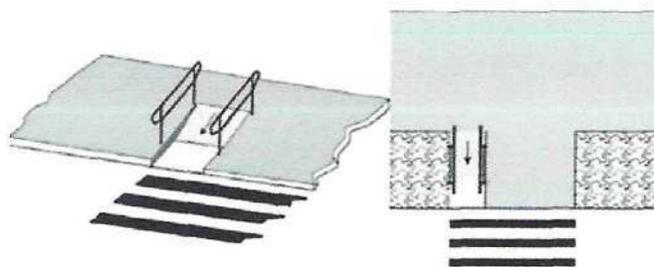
Вариант размещения пандусов на отнесенных пешеходных переходах, располагаемых на перегонах
